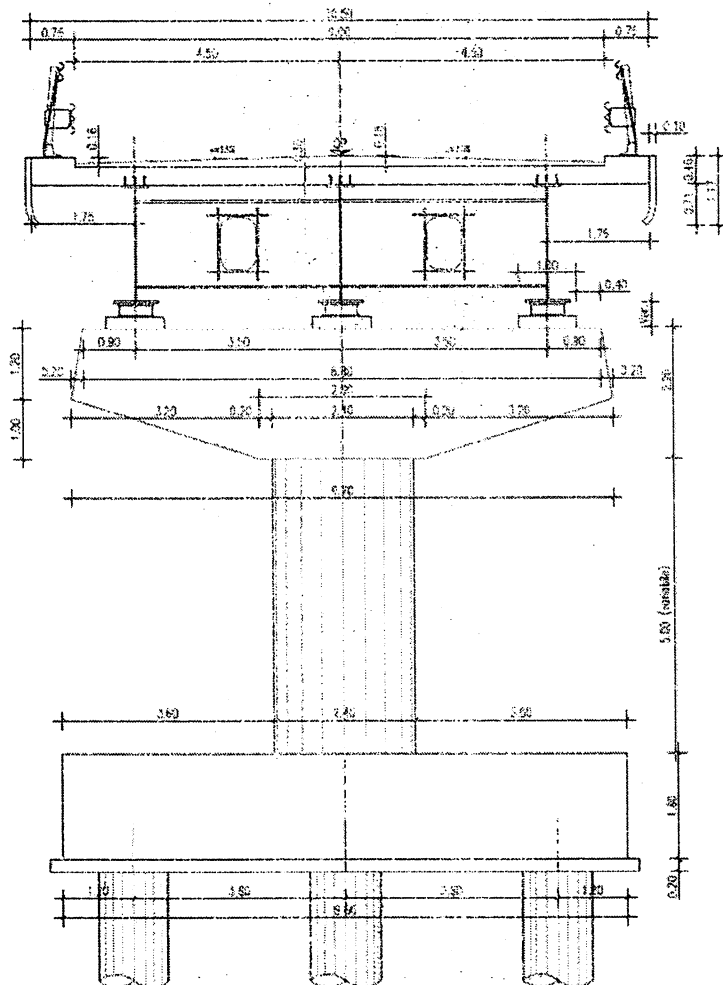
SEZIONE TIPO DELL'IMPALCATO DEI WADOTTI LUNGO IL Fiume MAGAZZOLO, CON LUCE TIPICA DI 40/45 M
